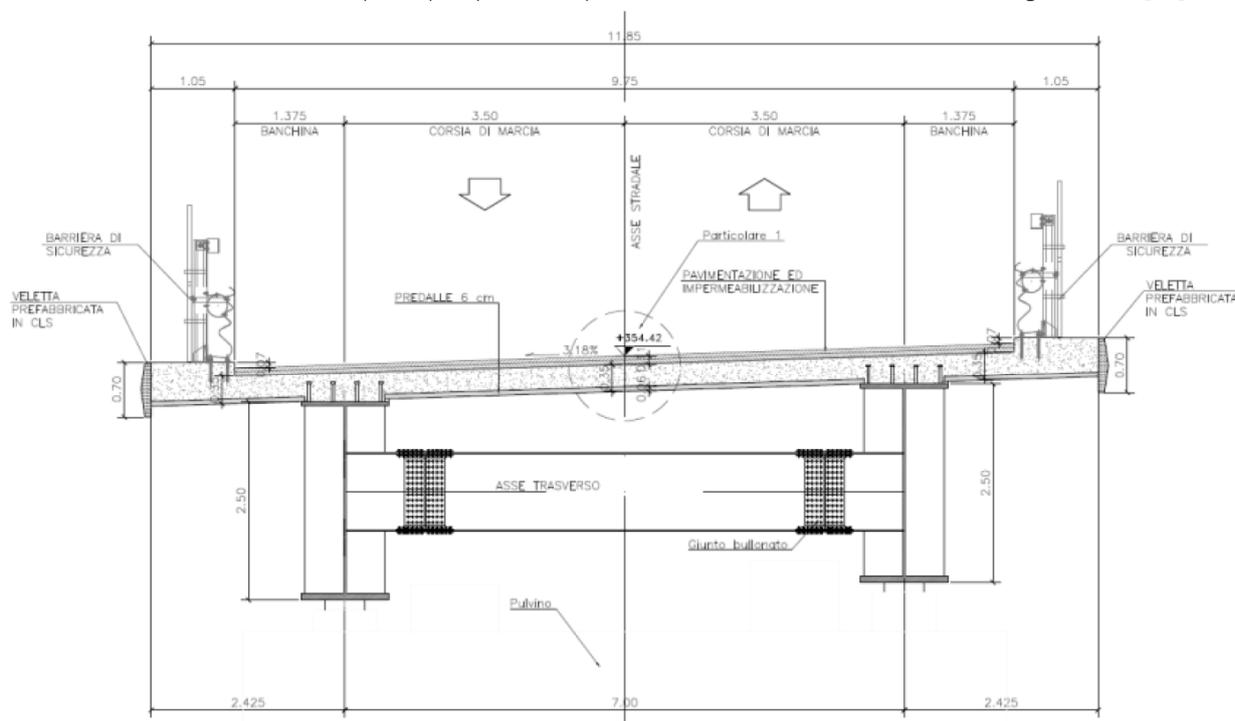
Sezione trasversale dell'impalcato del viadotto Molino Vecchio
